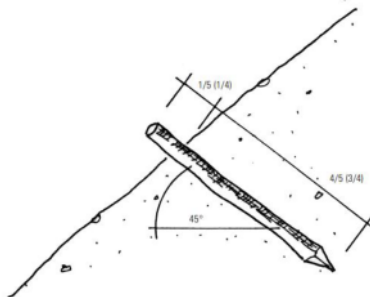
Fachgerechter Einbau von Steckhölzern (Quelle: Ingenieurblogische Bauweisen an Fließgewässern - Teil 3, LUBW)
